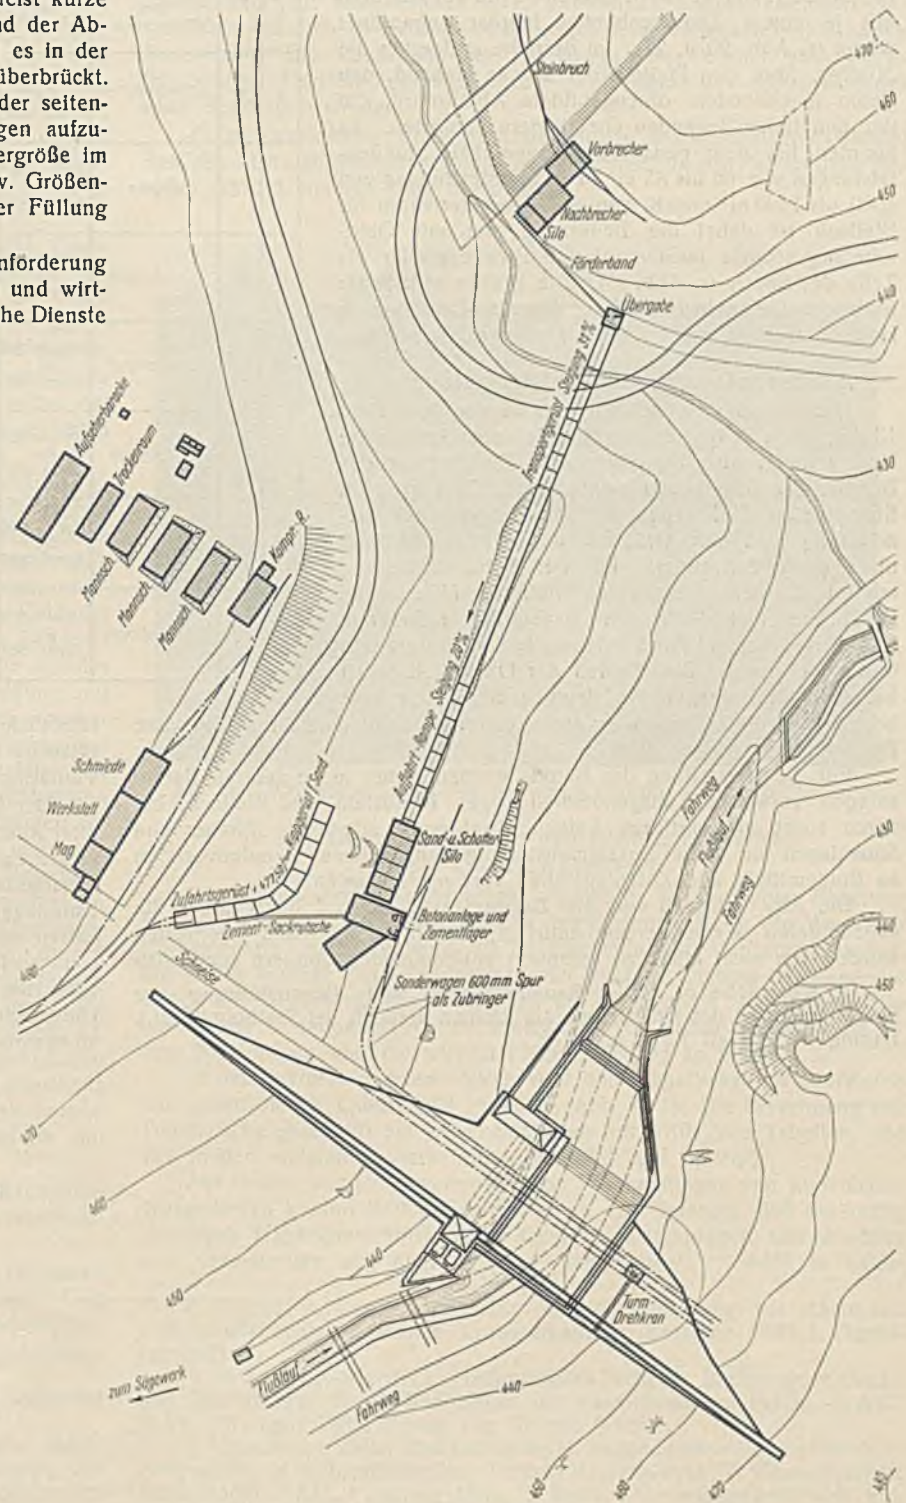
Zillierbachsperre. Baustelleneinrichtung. Lageplan.
